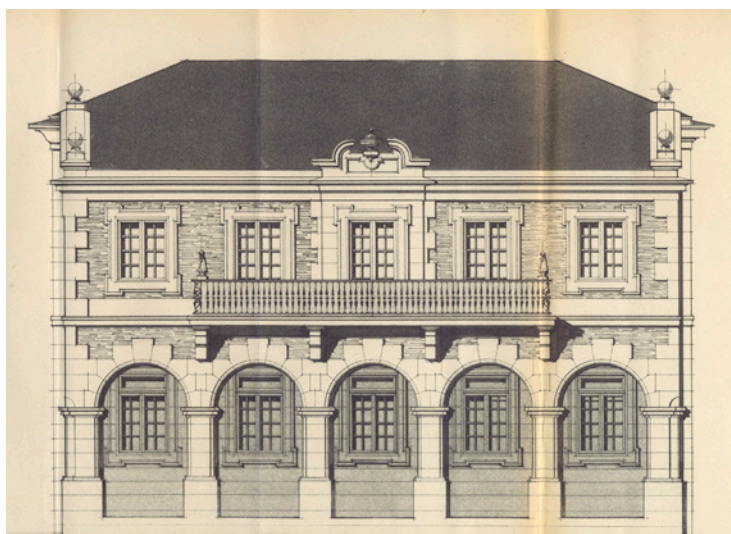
Alzado a la Rúa Nova. Proyecto de terminación del edificio del MPL. Arquitecto provincial (1968).
